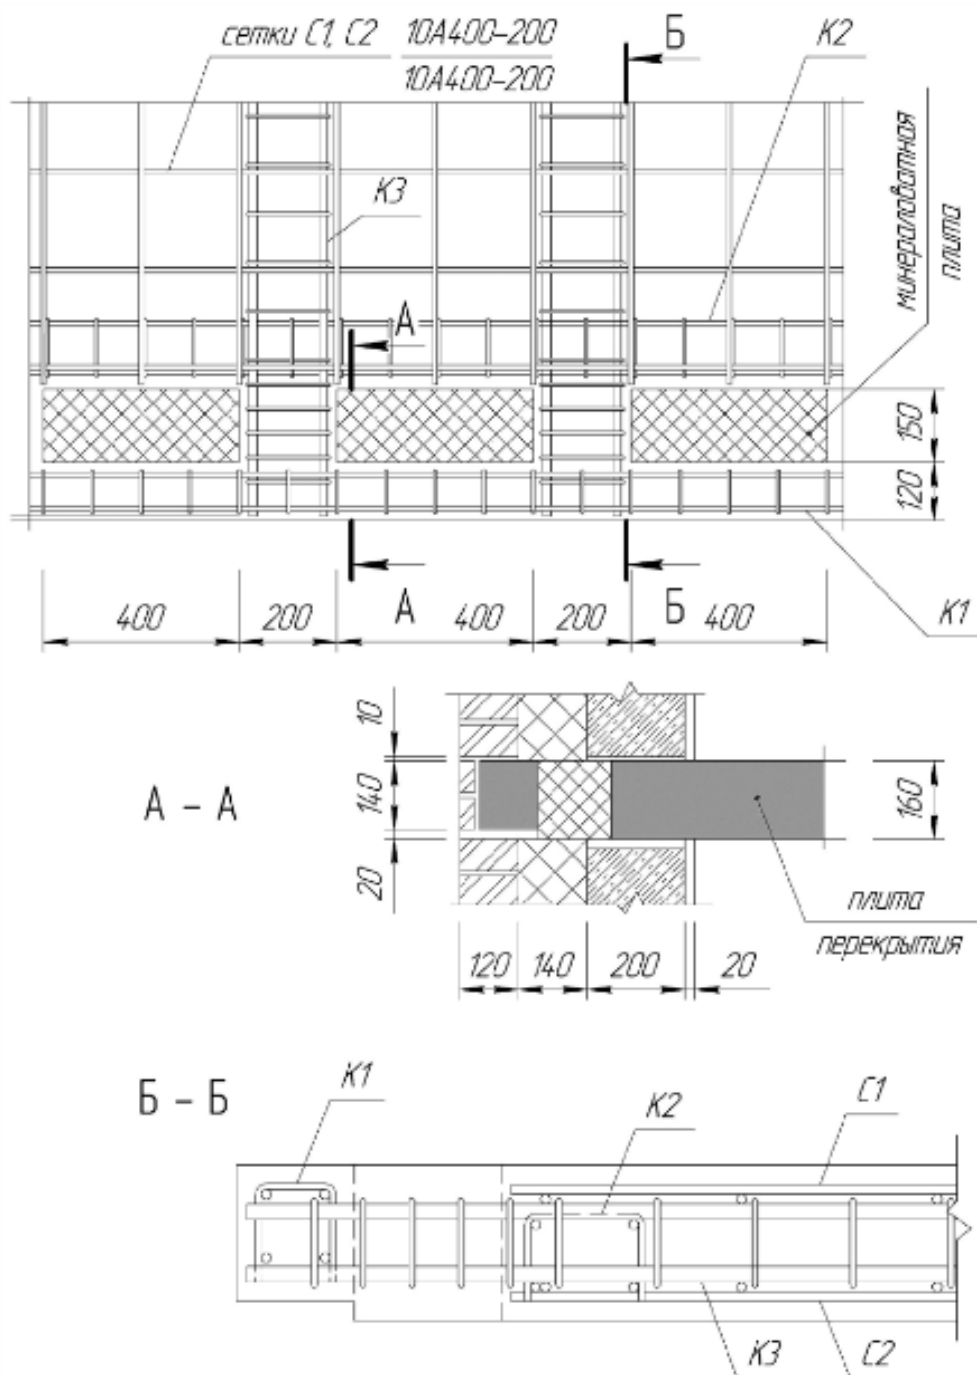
Схема армирования концевых участков плиты перекрытия
